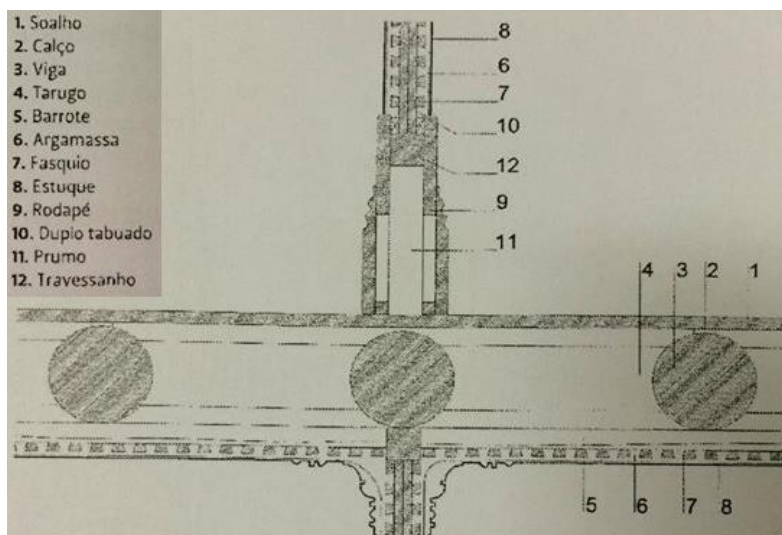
Pormenor construtivo do pavimento de madeira / parede interior [6]
